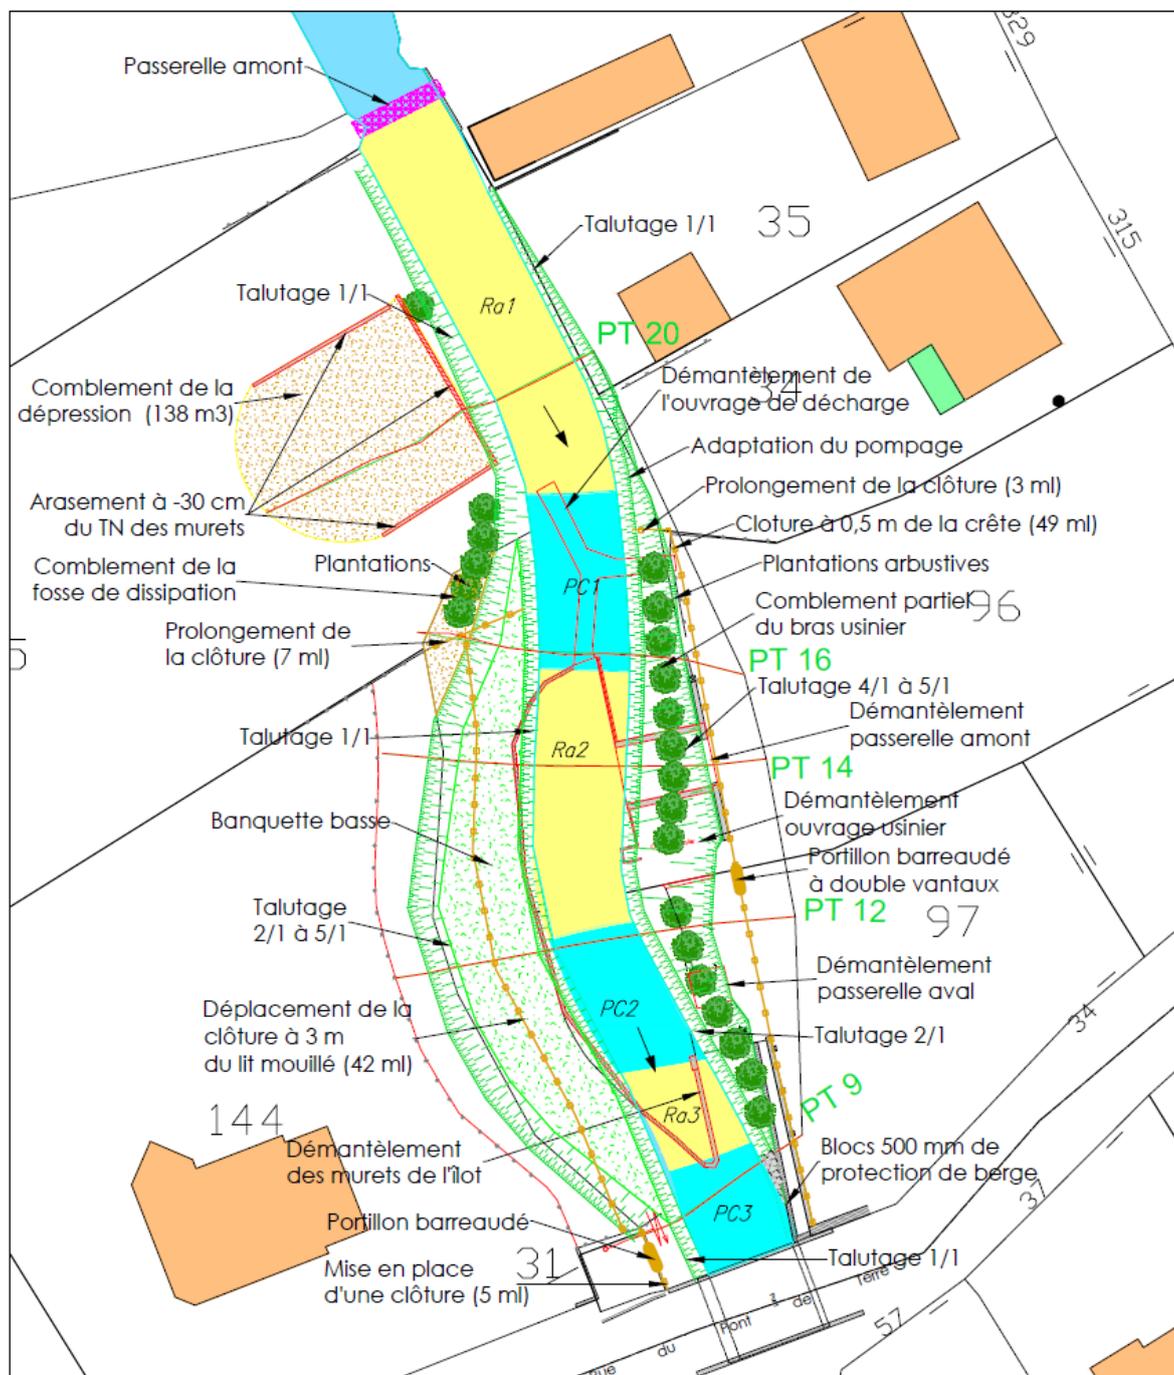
Plan de masse avec les couples hauteur/vitesse et faciès en état aménagé
